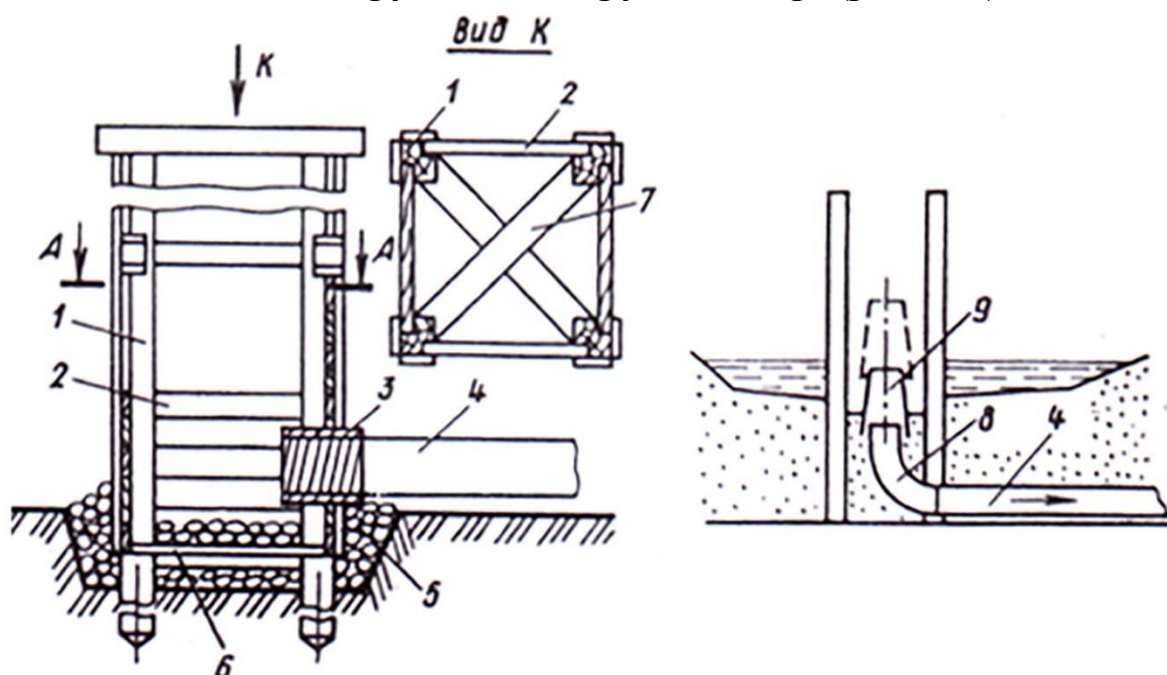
Водосбросные колодцы: а – деревянный с шандорами; б – с металлической трубой; 1 – стойки; 2 – шандоры (доски); 3 – уплотнение; 4 – водосбросная труба; 5 – камень (щебень); 6 – настил; 7 – распорки; 8 – отвод; 9 – патрубок (царга) для наращивания металлической трубы
